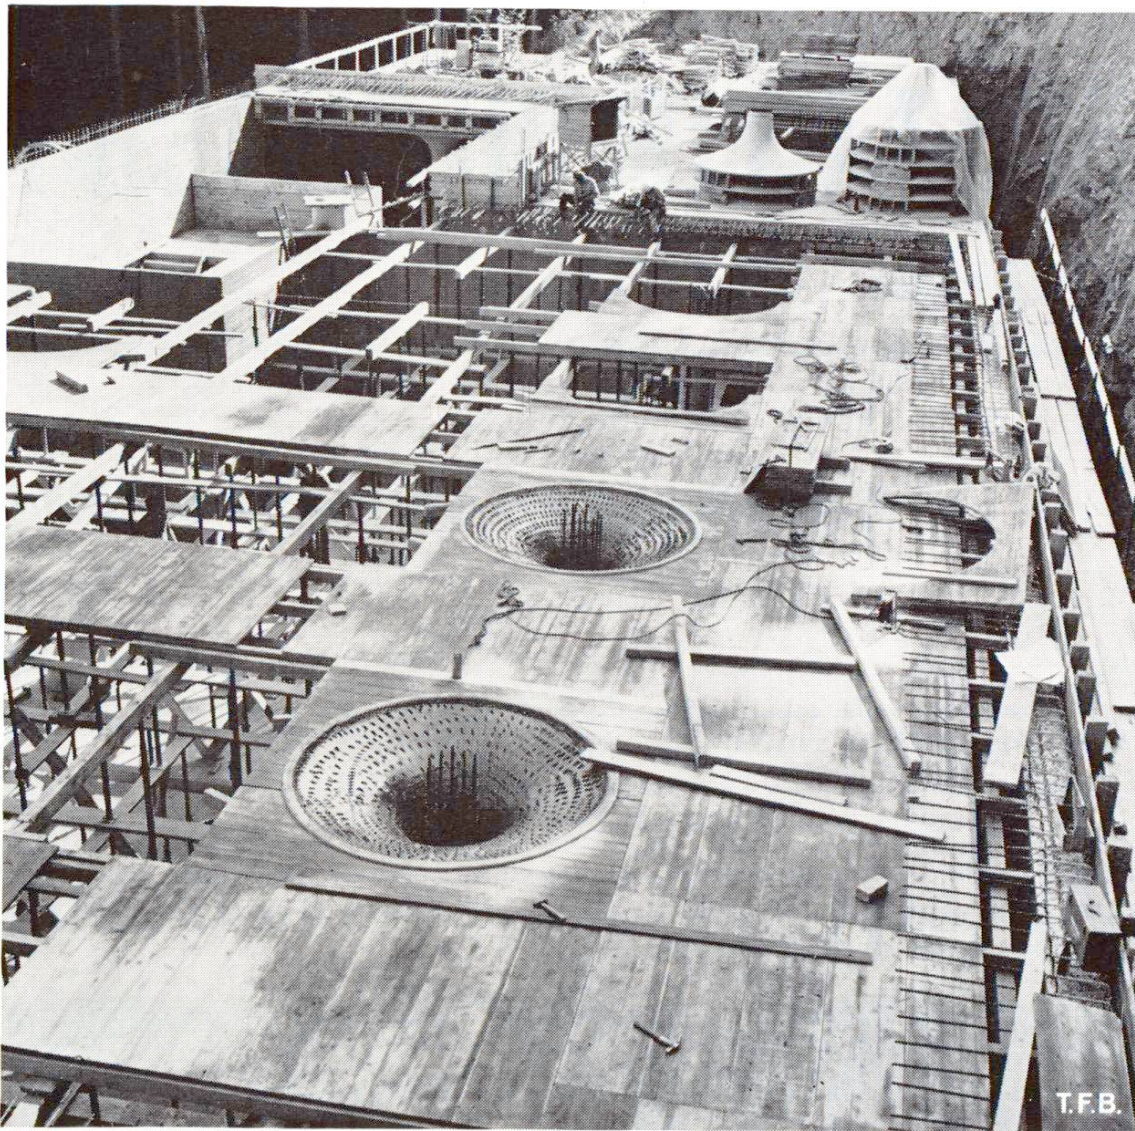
Vue générale du coffrage d'une dalle-champignon pour un grand réservoir à eau.
